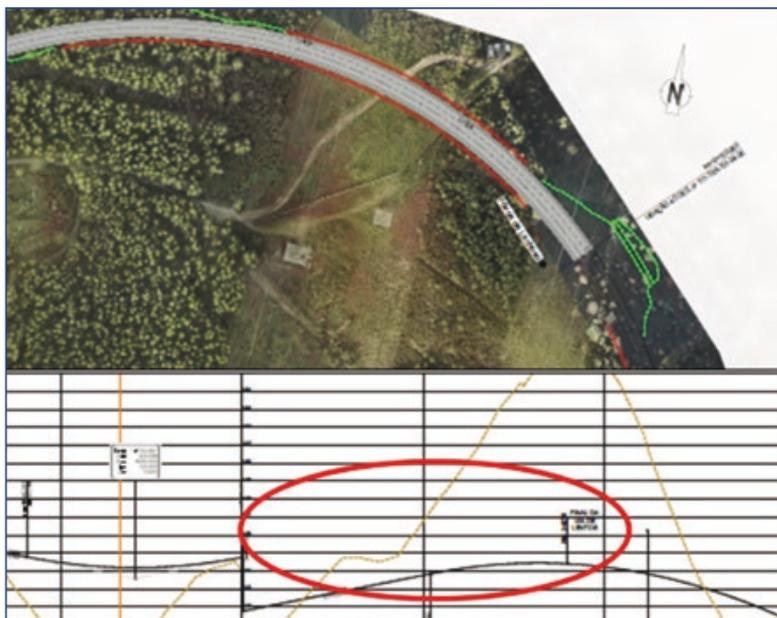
Planta / Perfil Longitudinal da Variante na zona final da Via de Lentos.
